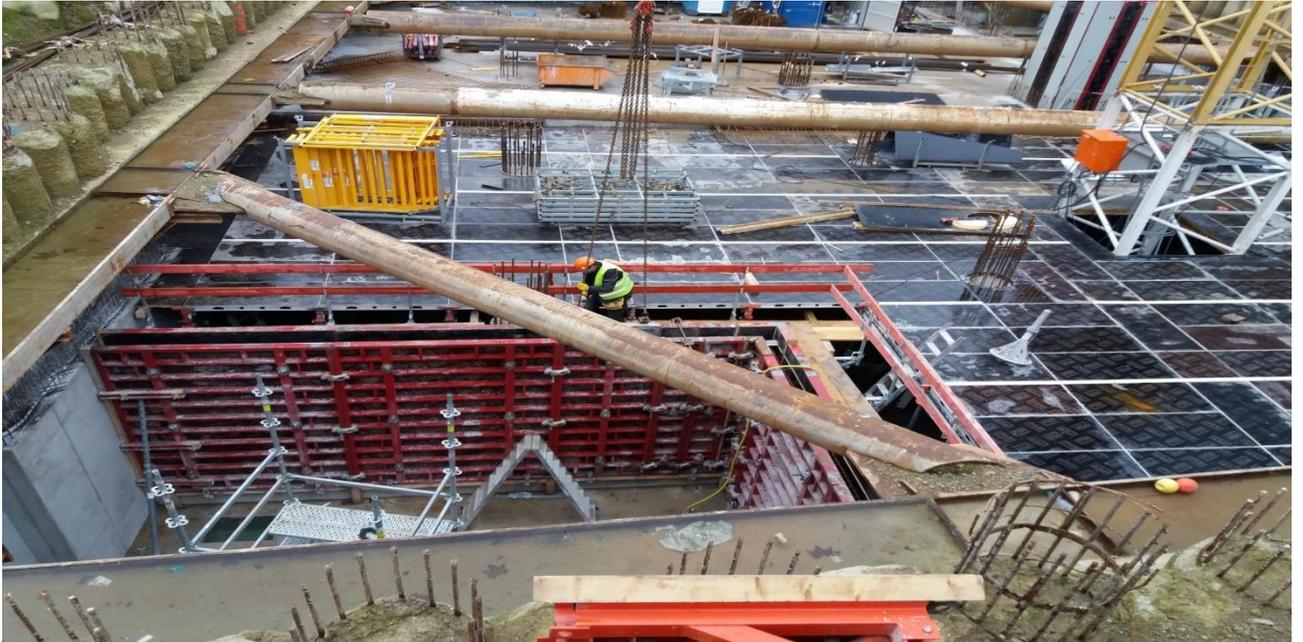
Монтаж опалубки и устройство проемов в перекрытии
